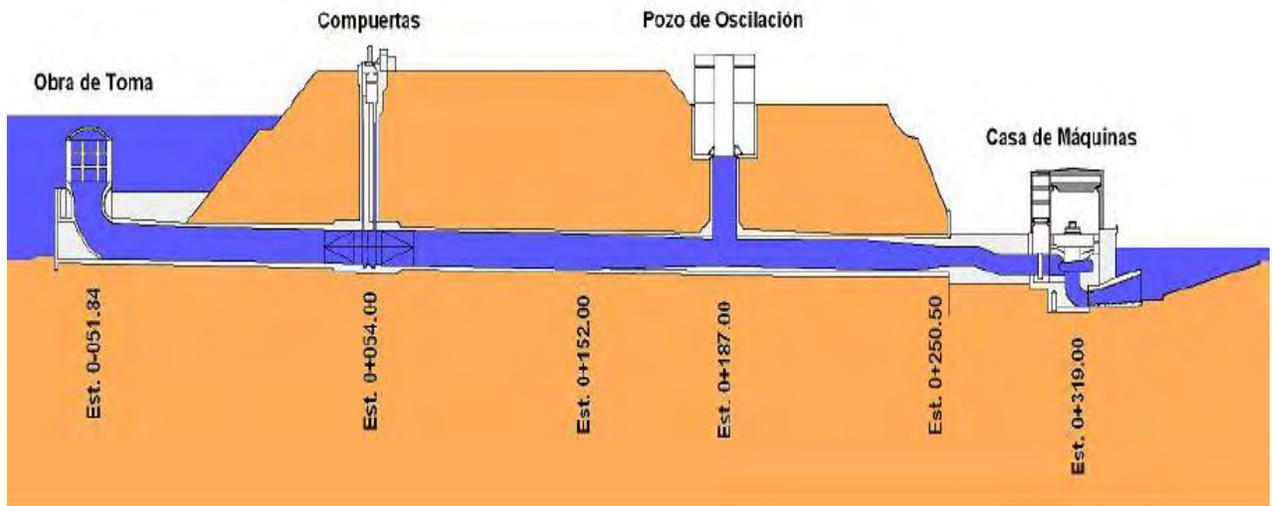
Corte longitudinal de las tuberías de conducción de la Central Hidroeléctrica La Villita.
